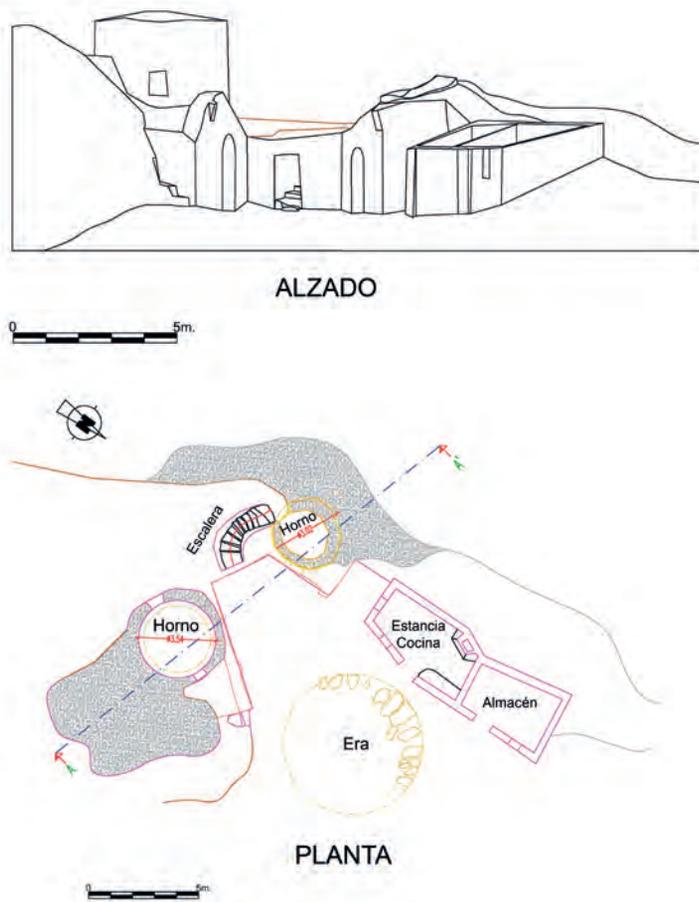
Alzado y planta del conjunto de hornos de yeso del Cerro del Sastre. Planimetría de Juan José Navarro Martínez.
